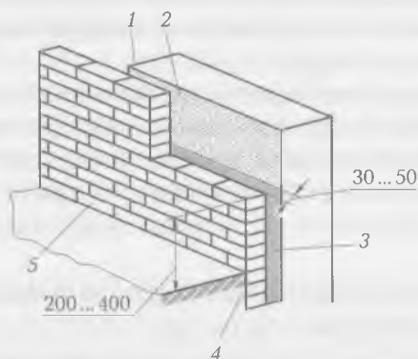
Устройство вертикальной литой асфальтовой гидроизоляции:
